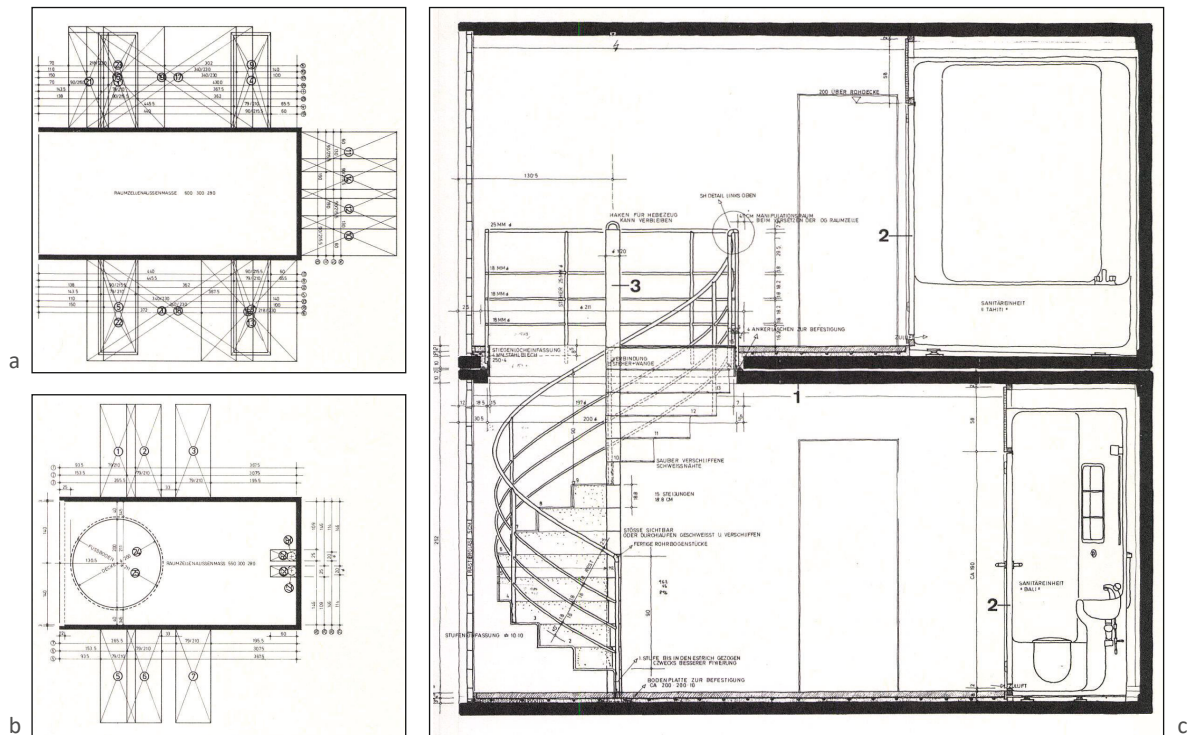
a Schema einer Zimmerzelle mit den Abmessungen 6,0 m x 3,0 m x 2,8 m
